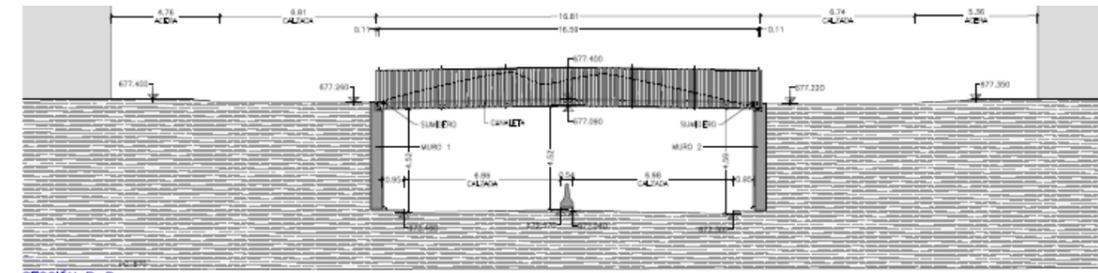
Alzado de la pasarela peatonal. Fuente: Proyecto
